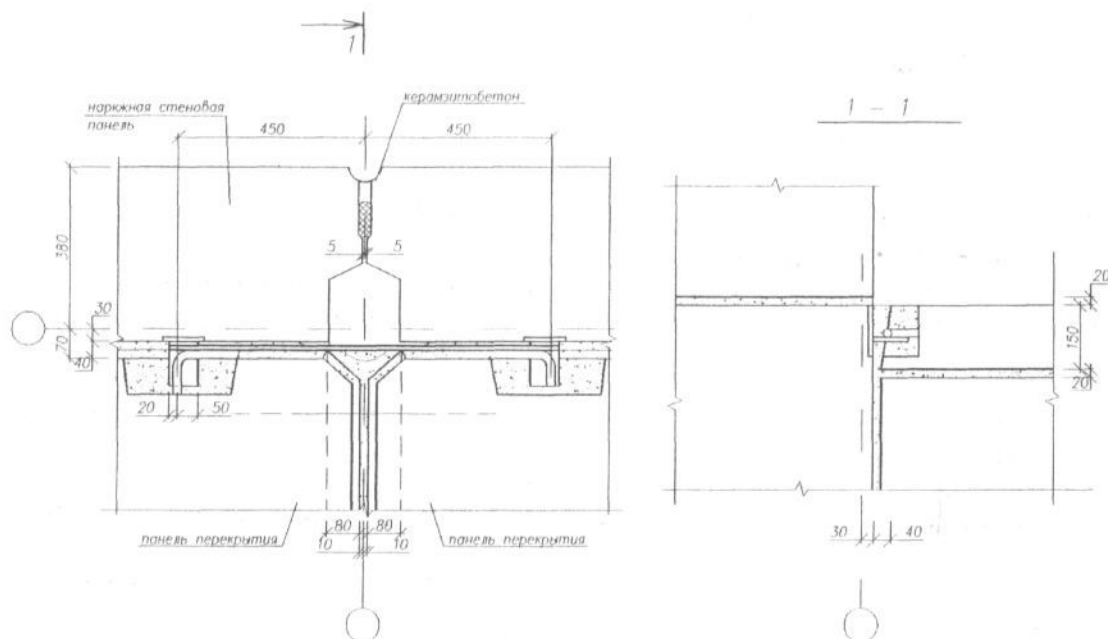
Стык наружных стеновых панелей с панелями перекрытия
